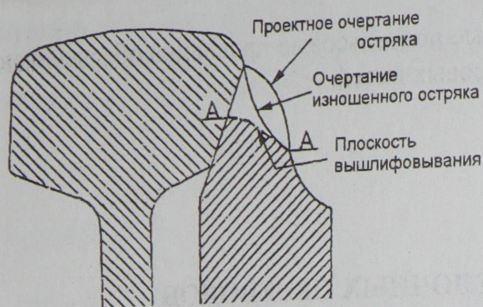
Схема наплавки остяка стрелочного перевода
